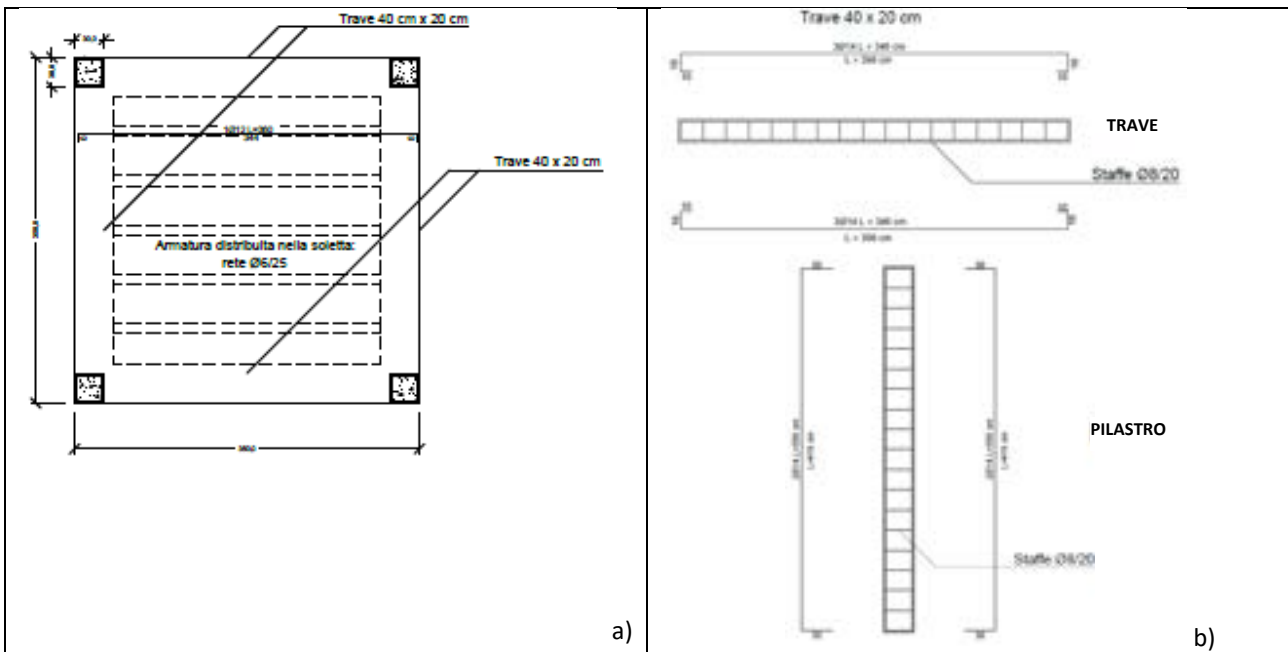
Elementi definitivi: a) Carpenteria solaio; b) Distinta armatura travi e pilastri
